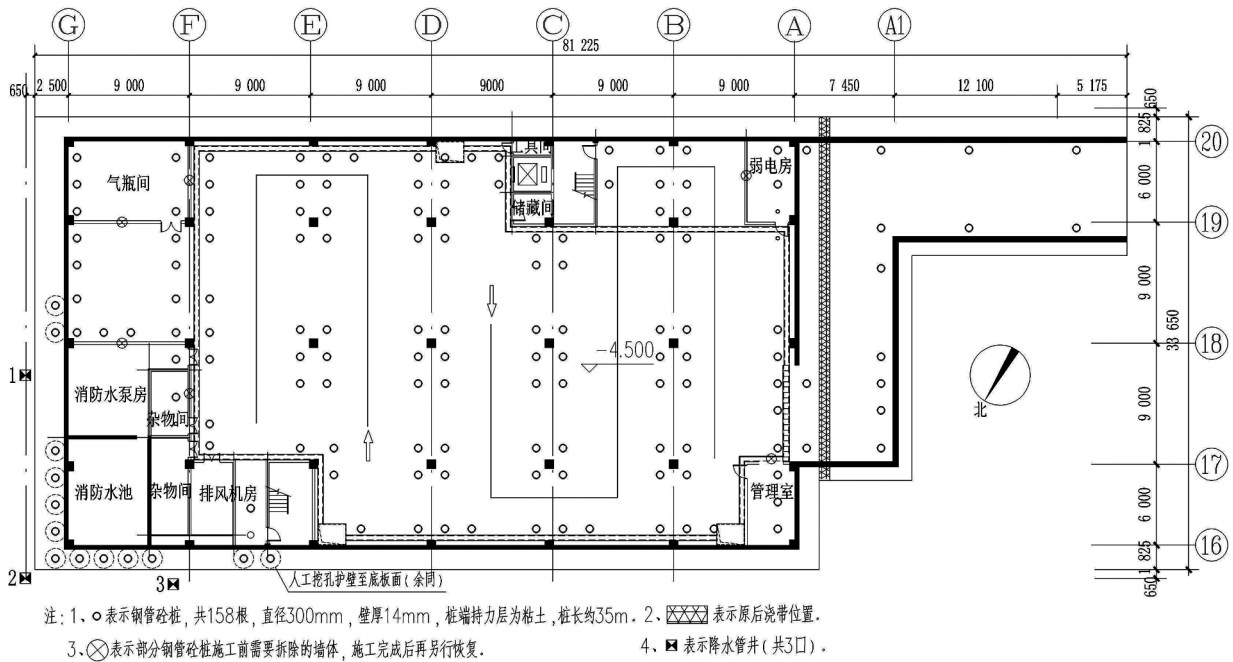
钢管混凝土桩加固平面布置图(单位:mm)
